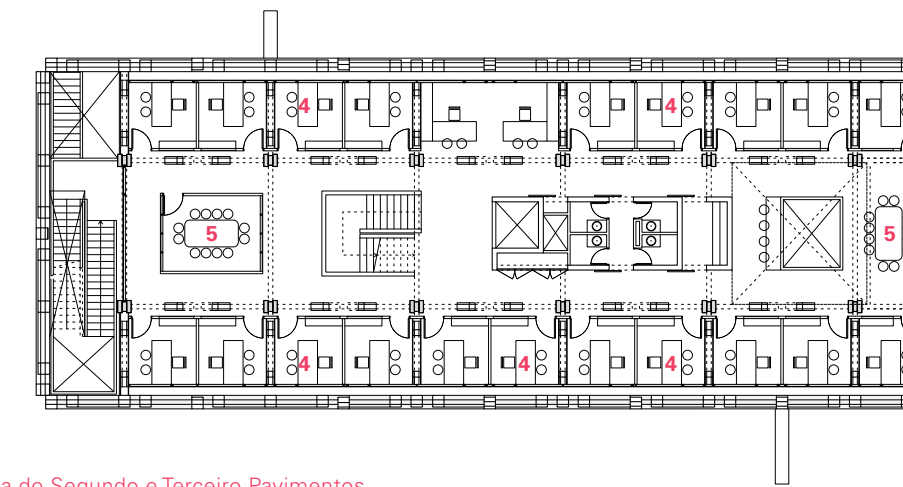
Planta do Segundo e Terceiro Pavimentos
